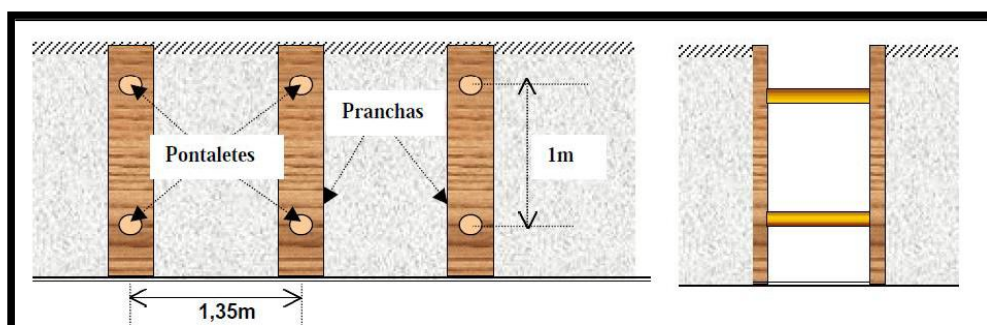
Pontaleteamento (corte longitudinal e transversal)
